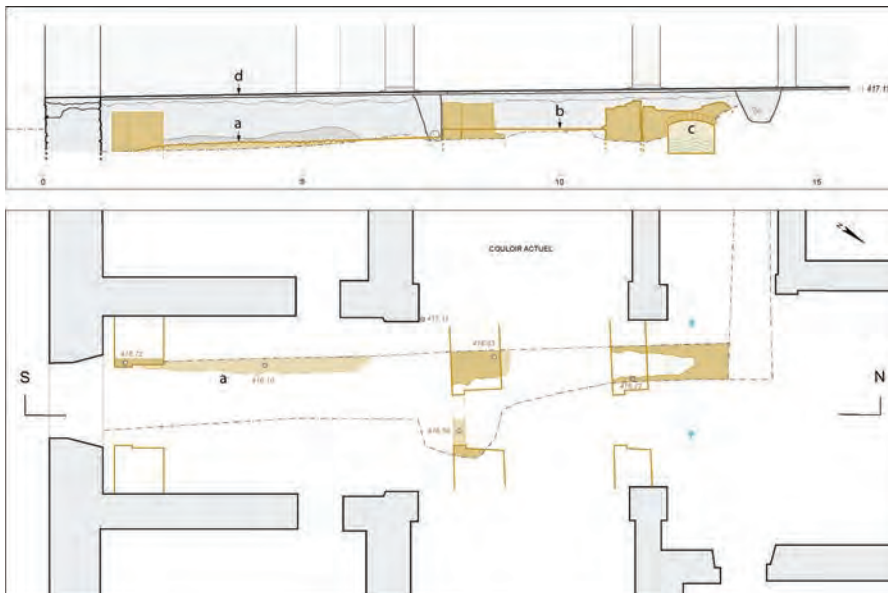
/5A. St-Maurice. Aile Sud du complexe abbatial (rez-de-bas au 1^{er} étage). Détail des niveaux repérés dans une tranchée (profil ouest en haut et plan en bas vers le sud-ouest). Fouilles 2002.
